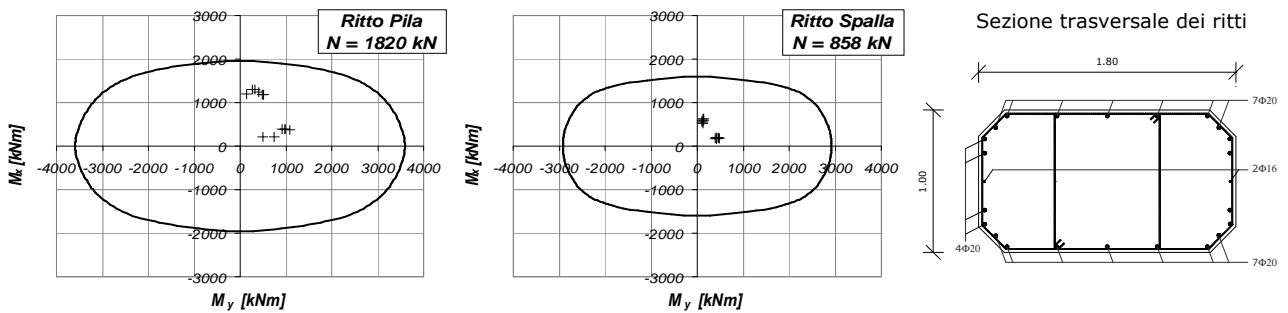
Verifiche di resistenza delle sezioni di base dei ritto esterni delle pile e delle spalle.
